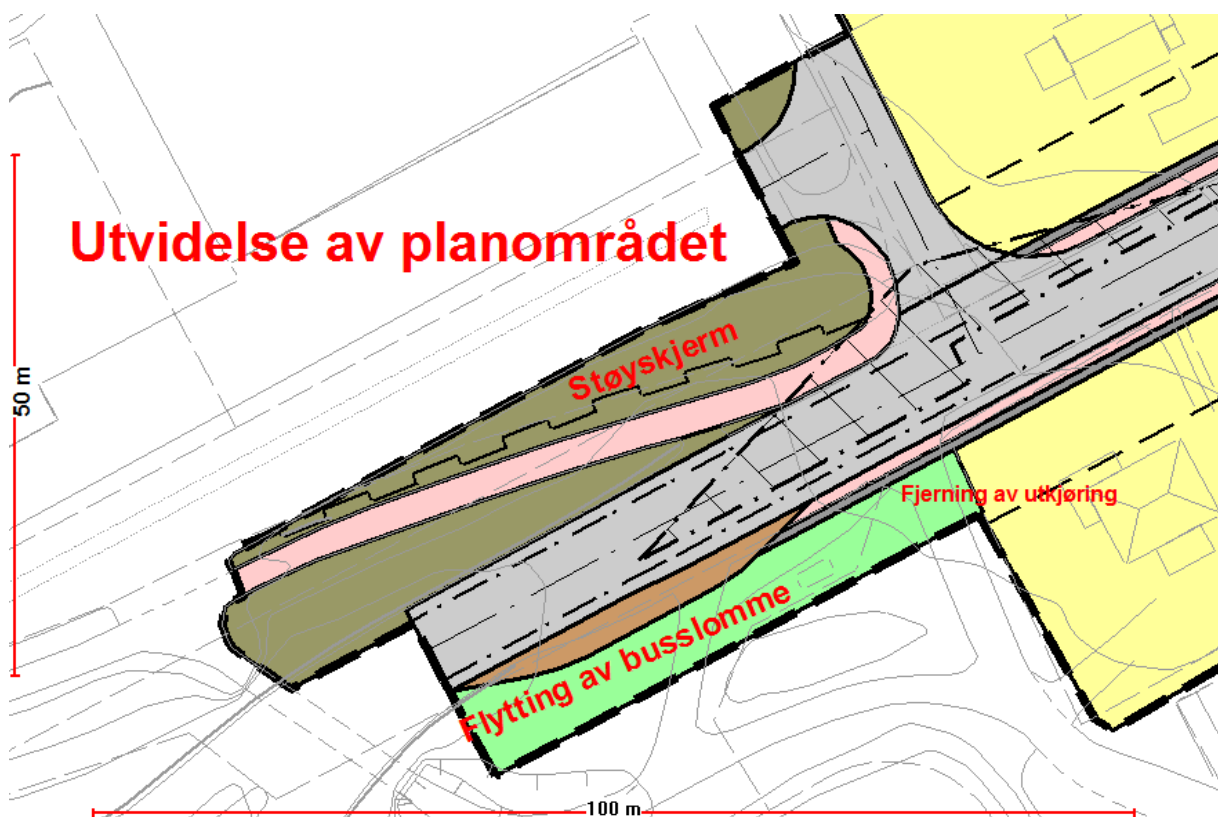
Utvidelse av planområdet mot idrettshall, idrettsbane og rundkjøring.
